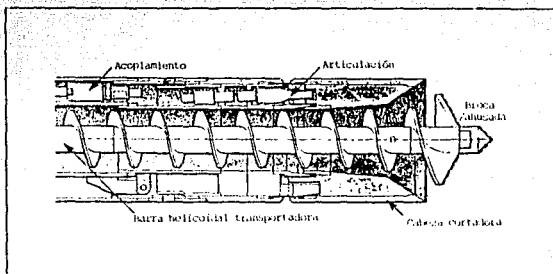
Perforador Auger con broca ahusada. (Witte Thrushoring Machine). Ref. 11, pág. 16.
